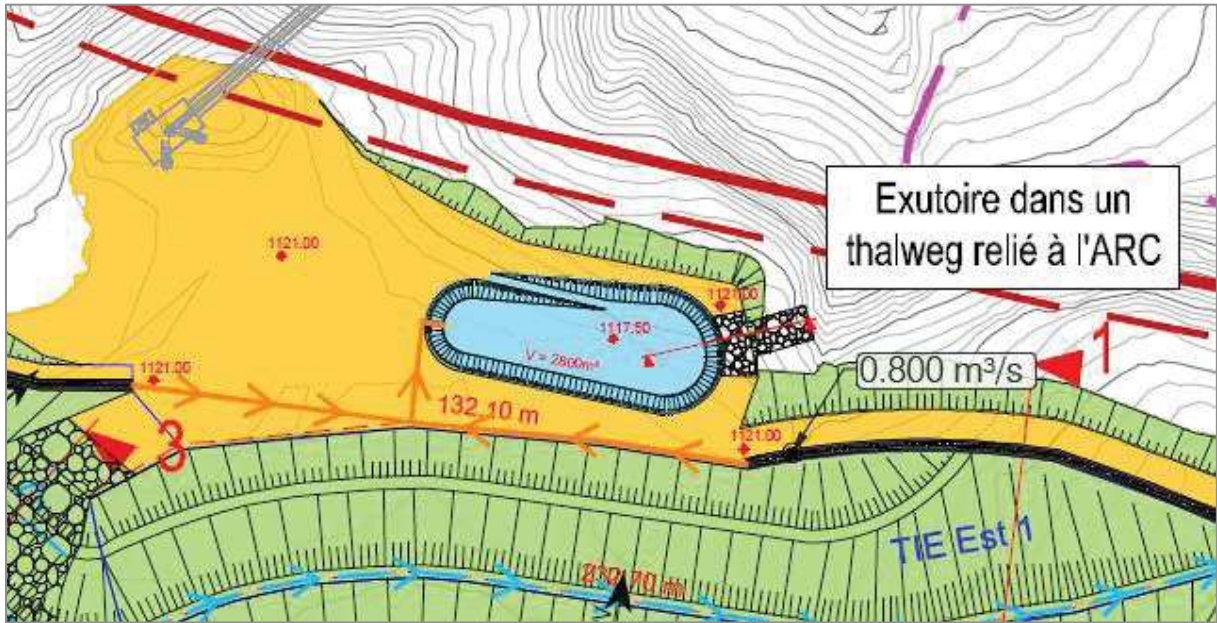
Zoom sur le bassin de décantation du site (ALTI, juin 2021)
